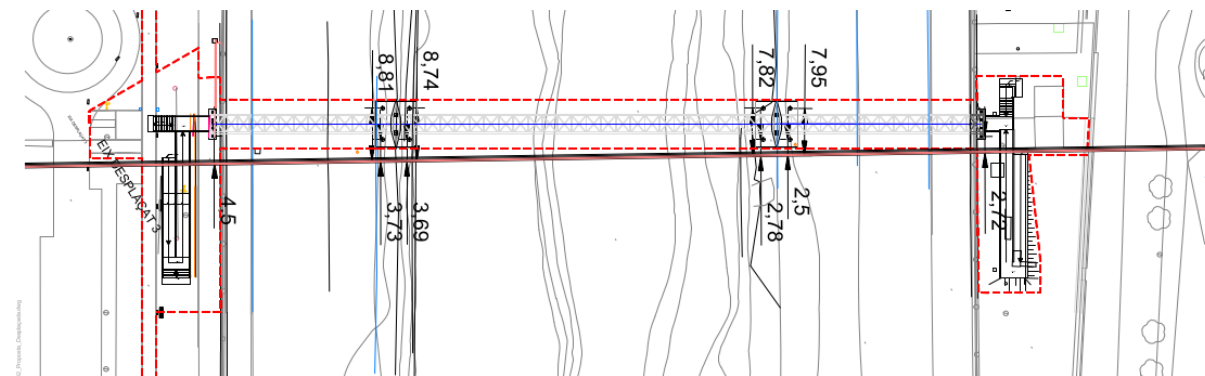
Planta coordinació nova posició de la passarel·la sobre el riu Besòs i escomesa elèctrica existent
